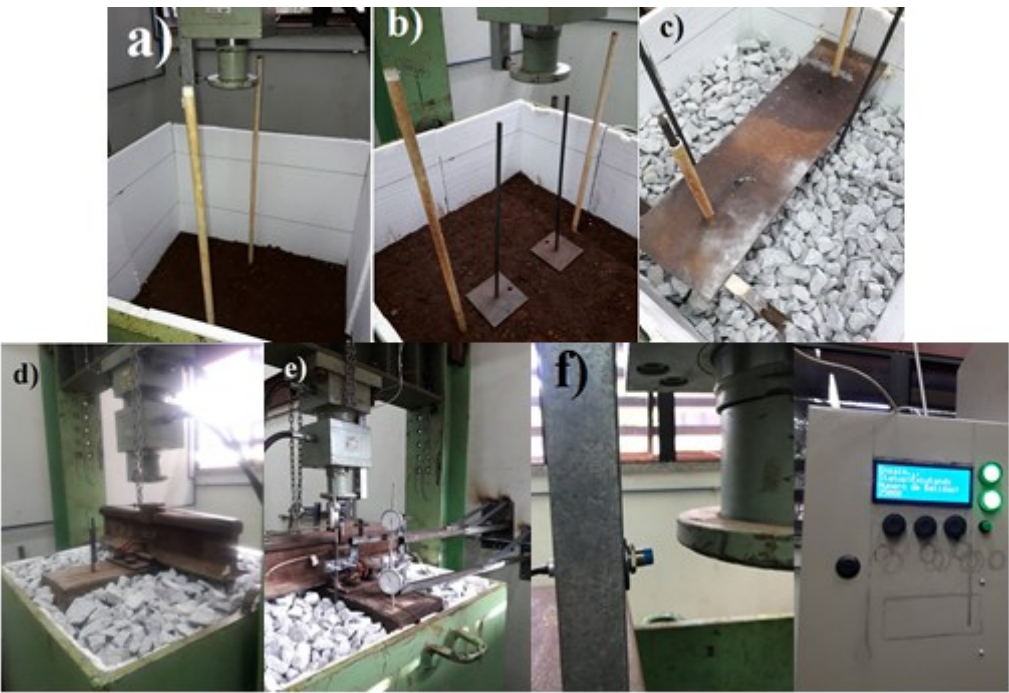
a) Hastes de recalque posicionadas no topo da camada de subleito; b) Hastes de reforço posicionadas no topo da camada de sublastro; c) colocação da brita; d) instalação de travessa, trilho e elementos de fixação; e) extensômetros instalados; f) sensor de batimento e contador.
